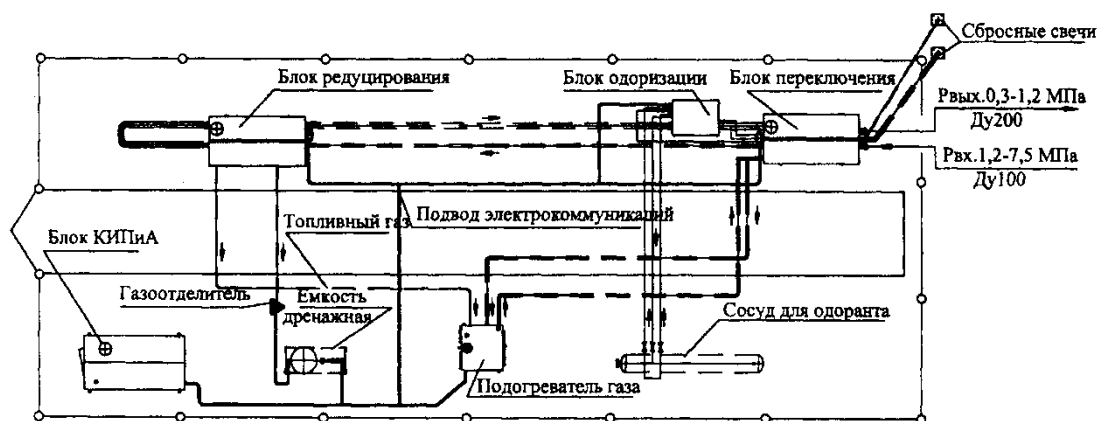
Схема размещения блоков станции "ЭНЕРГИЯ-1М" на площадке
